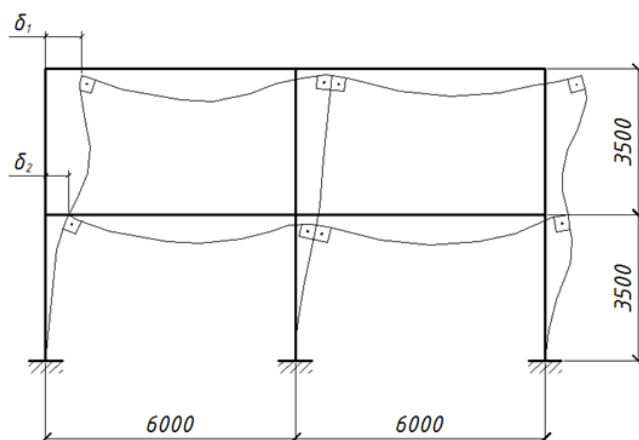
Деформированное состояние рамы (с жестким соединением колонны с фундаментом)
